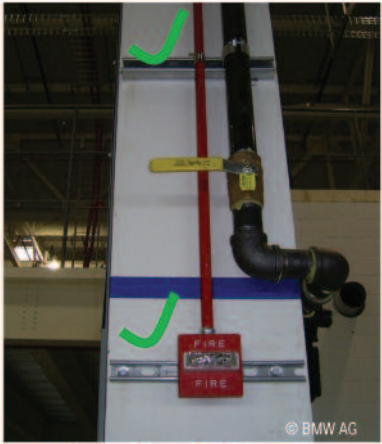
Auszug aus Planungsrichtlinie: Wartungslasten
